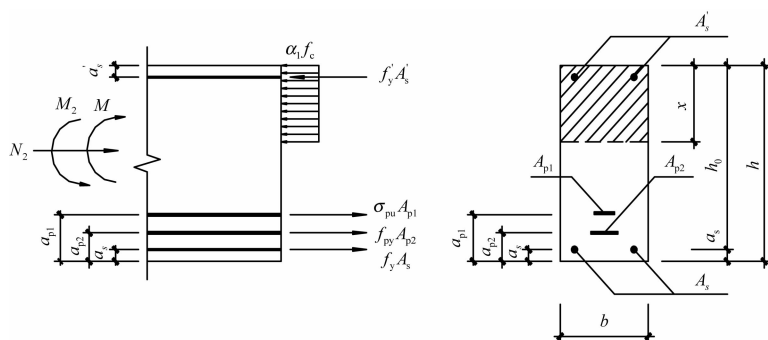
混合配置预应力钢筋混凝土受弯构件
